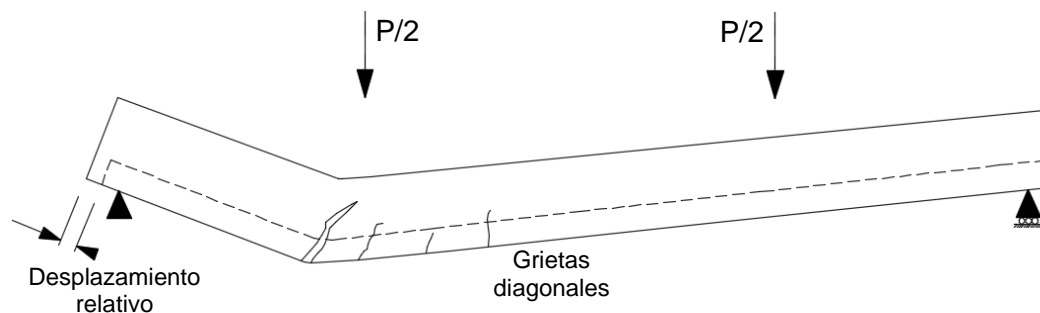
Grieta diagonal en la losa.
